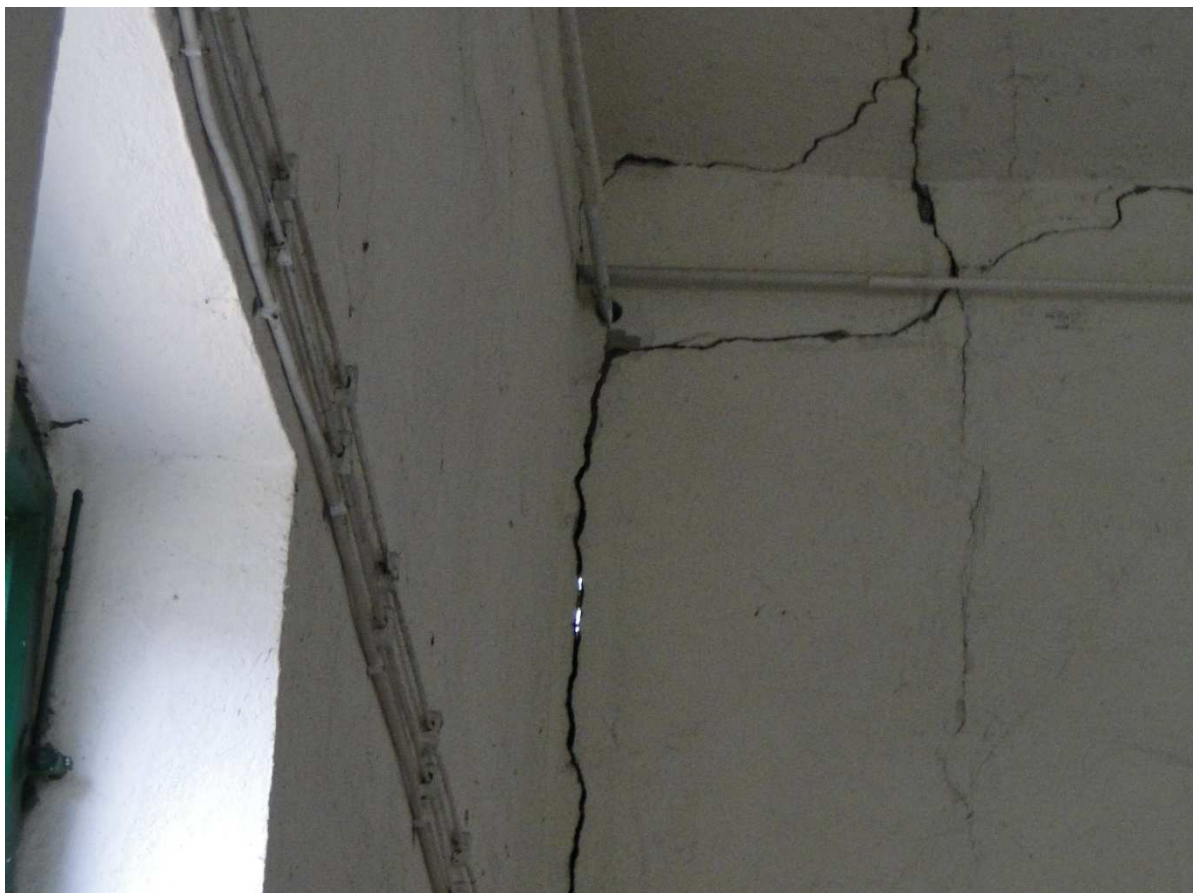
Widok zarysowań poprzecznych stropu oraz słupa
